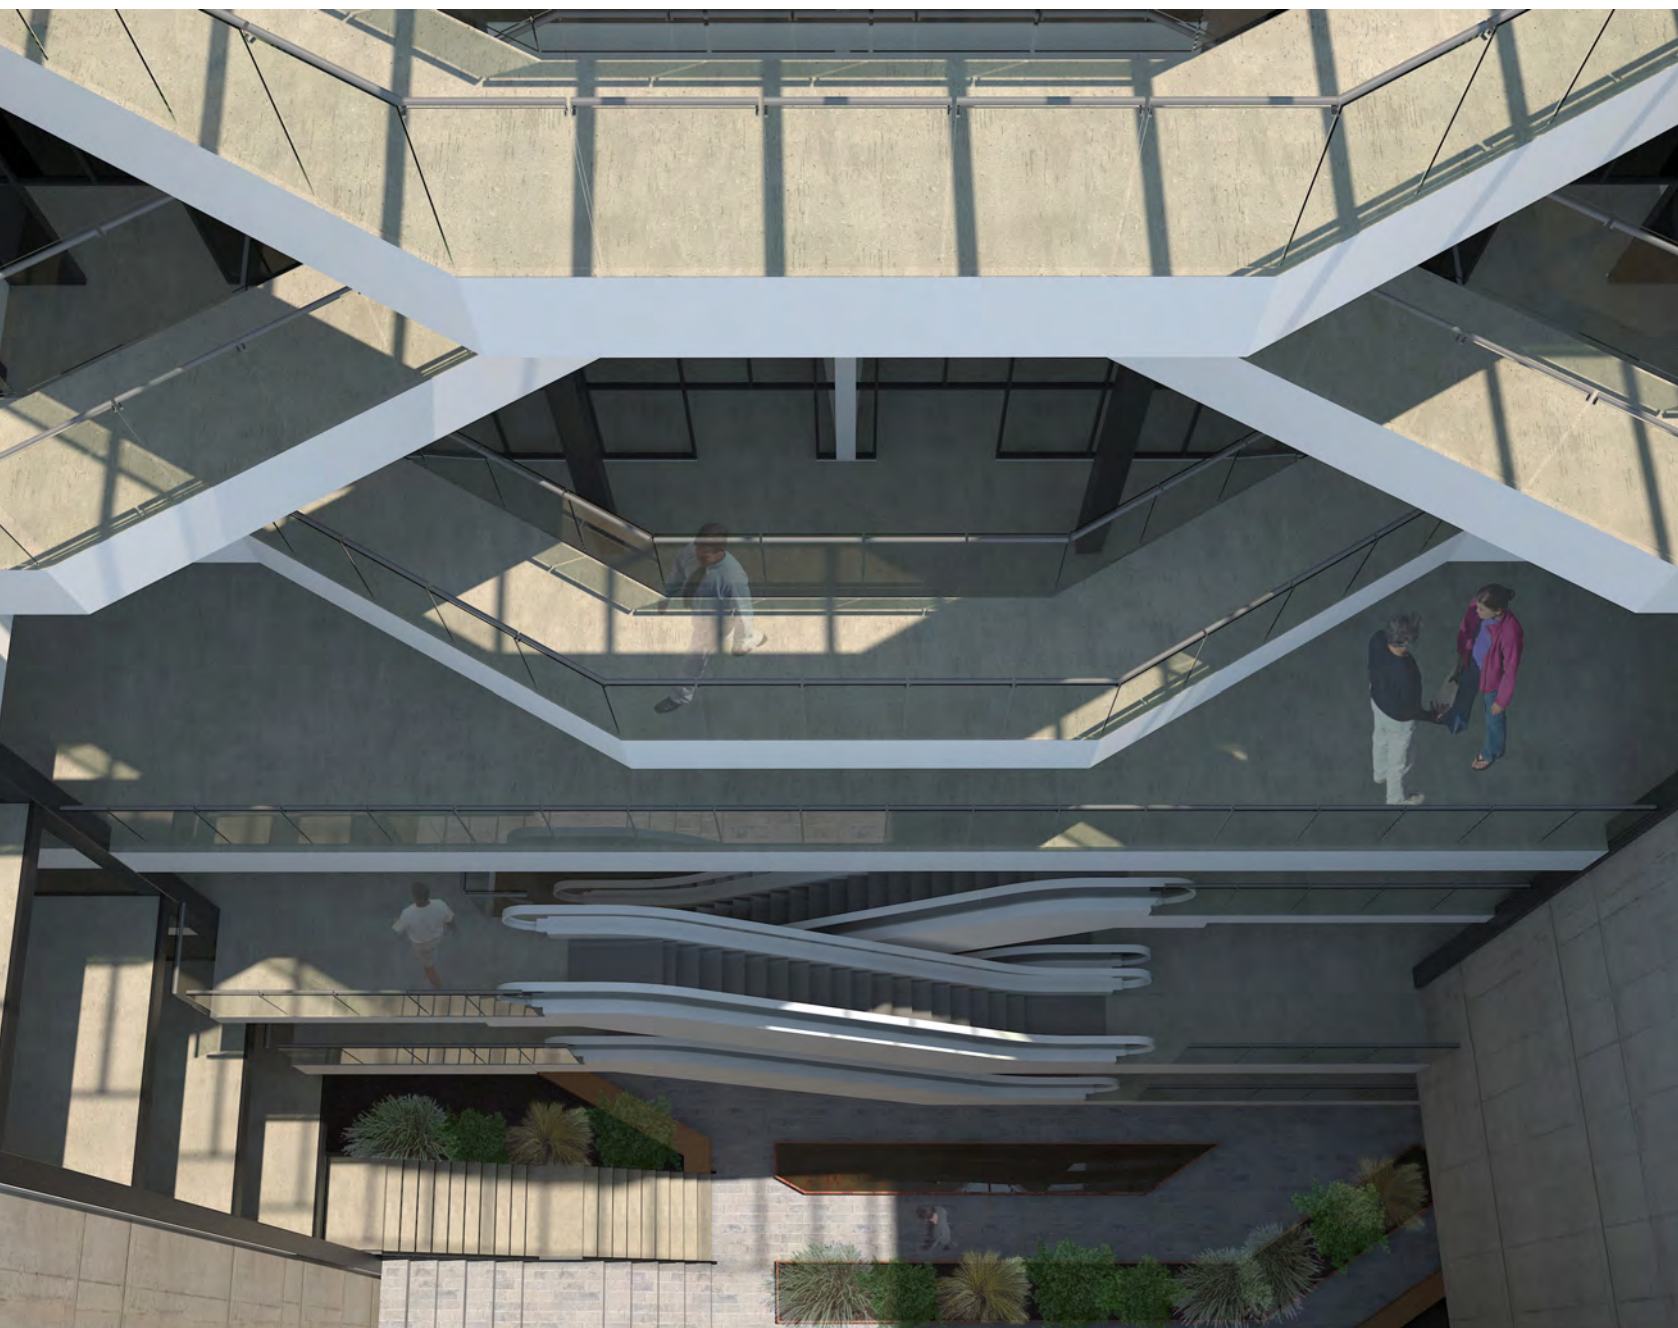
| Vista en planta de las principales circulaciones horizontales del proyecto
